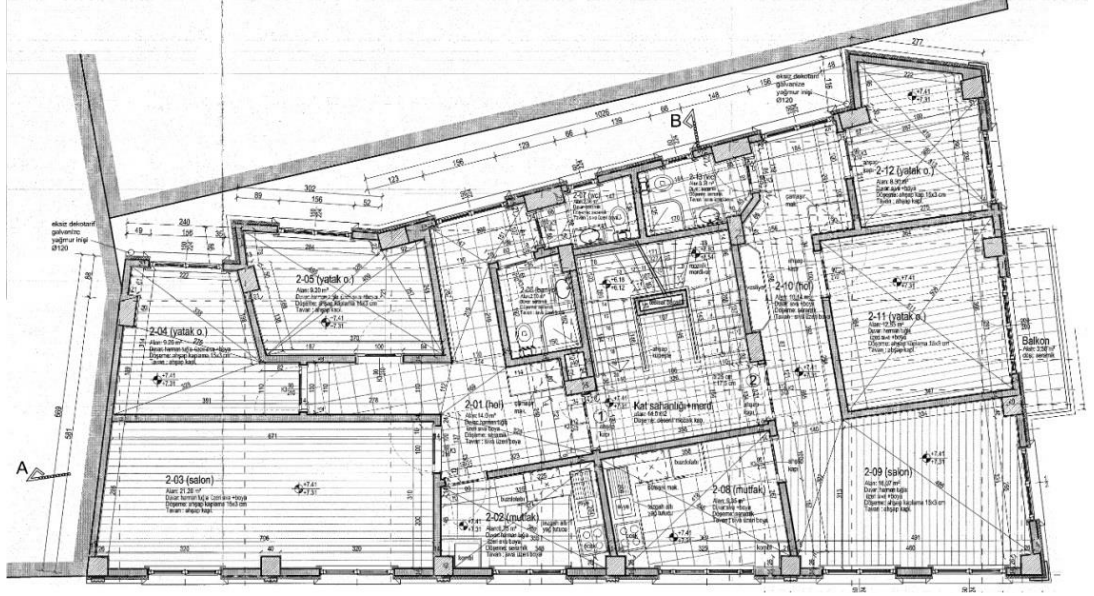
Hasan Nuri Bey Apartmanı Planı (Necmettin, 1933)
